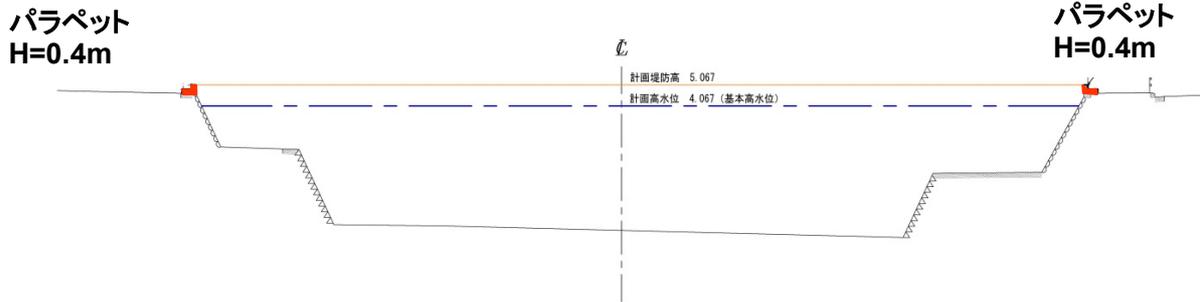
下流かさ上げ区間の代表断面 標準断面図 (1.932km)
